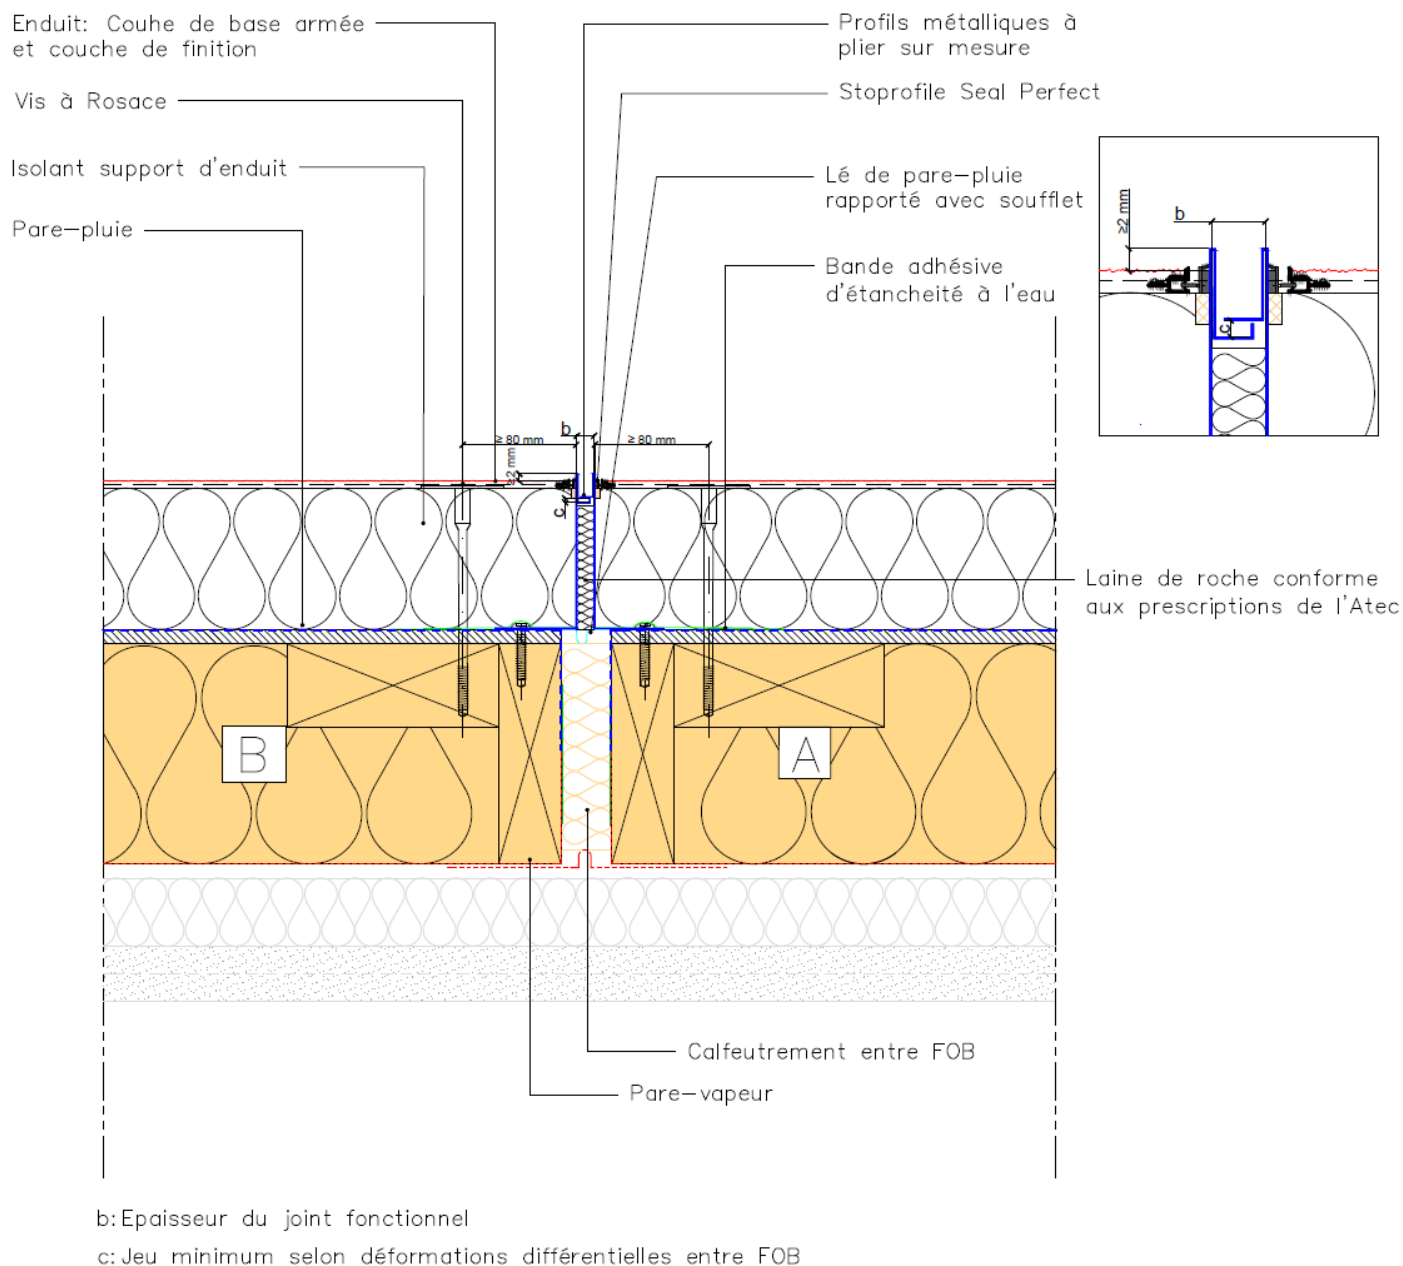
Jonction ETICS / ETICS dans un même plan entre 2 panneaux de FOB juxtaposés – Profil acier - Coupe Horizontale
